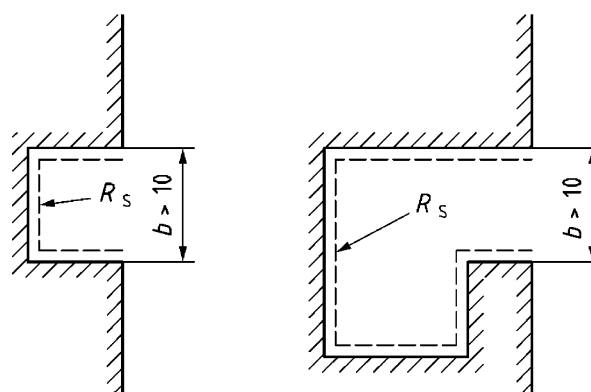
Exemplos para cavidades e ranhuras bem ventiladas
